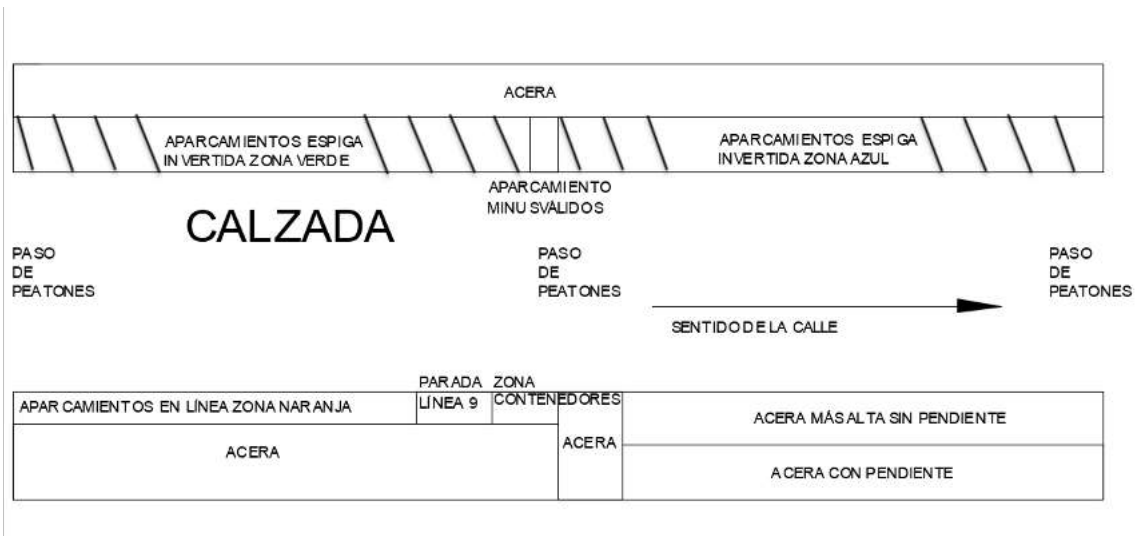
Esquema aproximado de como quedaría la calle en planta. Fuente: Elaboración propia.
